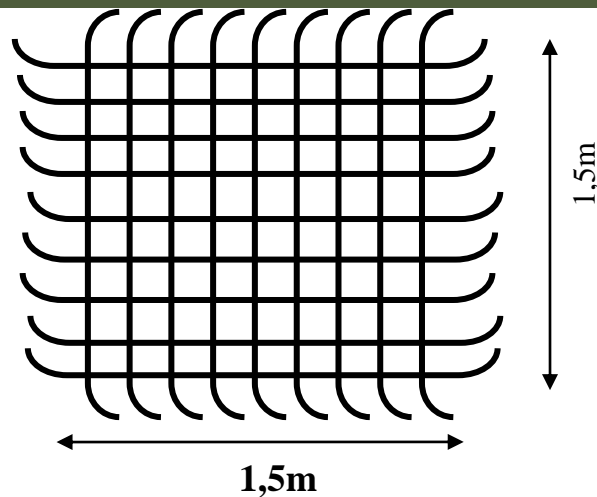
Vue en plan d'un croqué de ferrailage de la semelle
